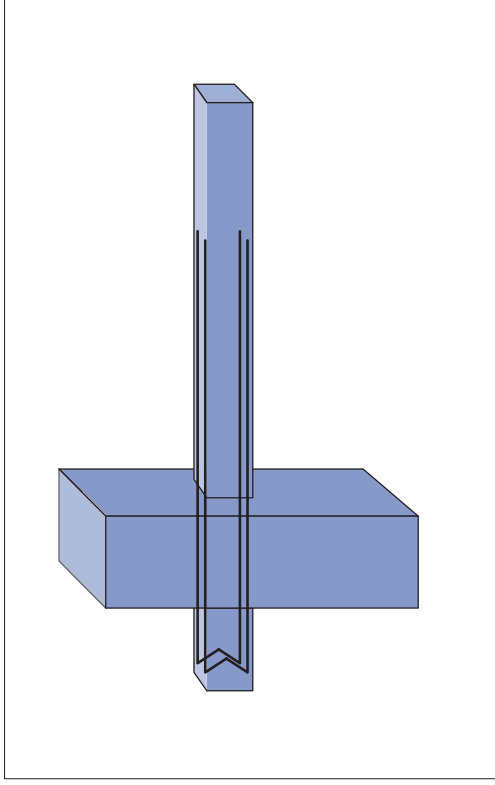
Ergot extérieur au nœud poutre-poteau
